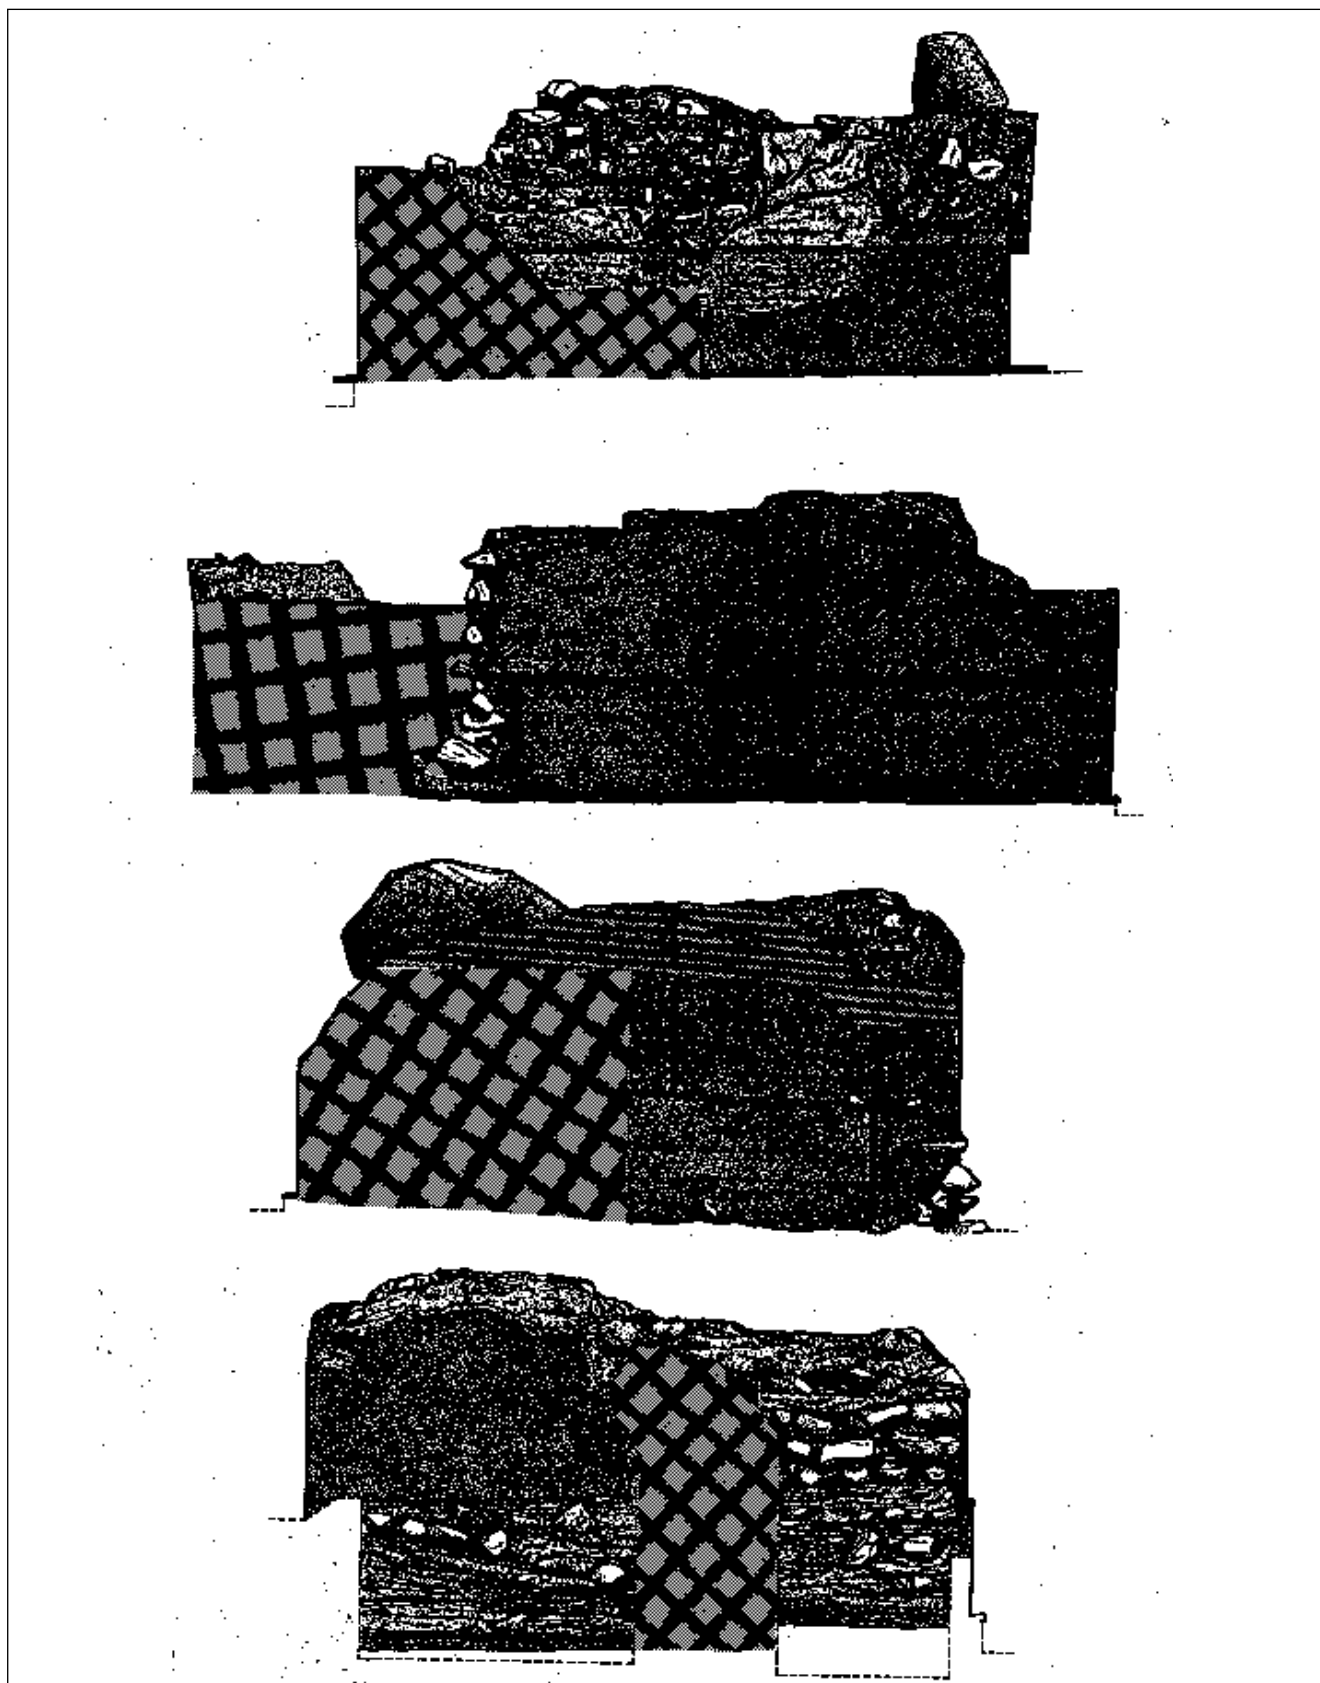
a 20. Torre islámica Casa del Obispo. Alzado Norte; alzado Oeste; Alzado Sur y Alzado Este.
